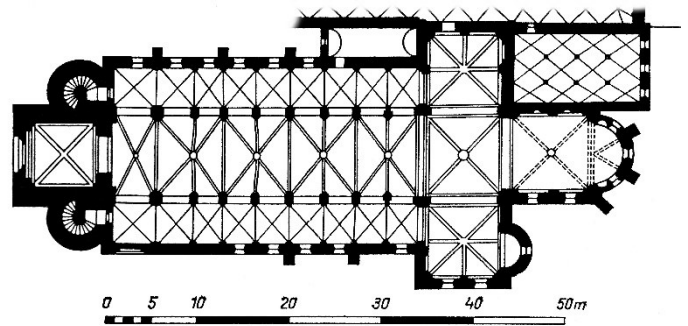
Grundriss der Liebfrauenkirche Magdeburg
